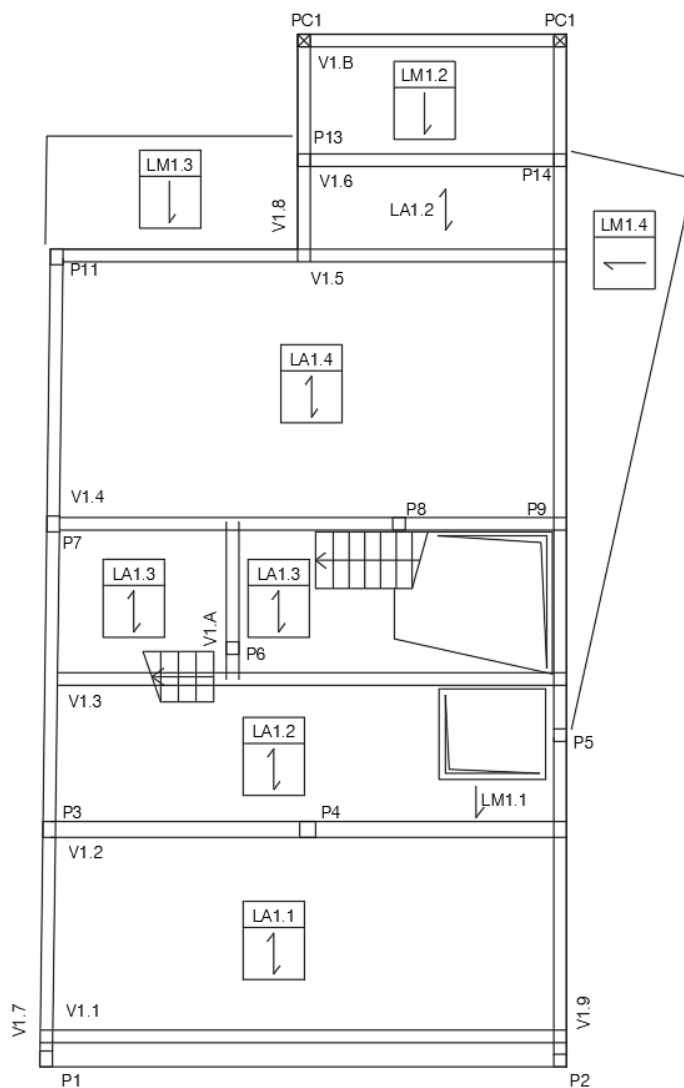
Esquema estrutural do piso elevado (Projeto de estruturas).
